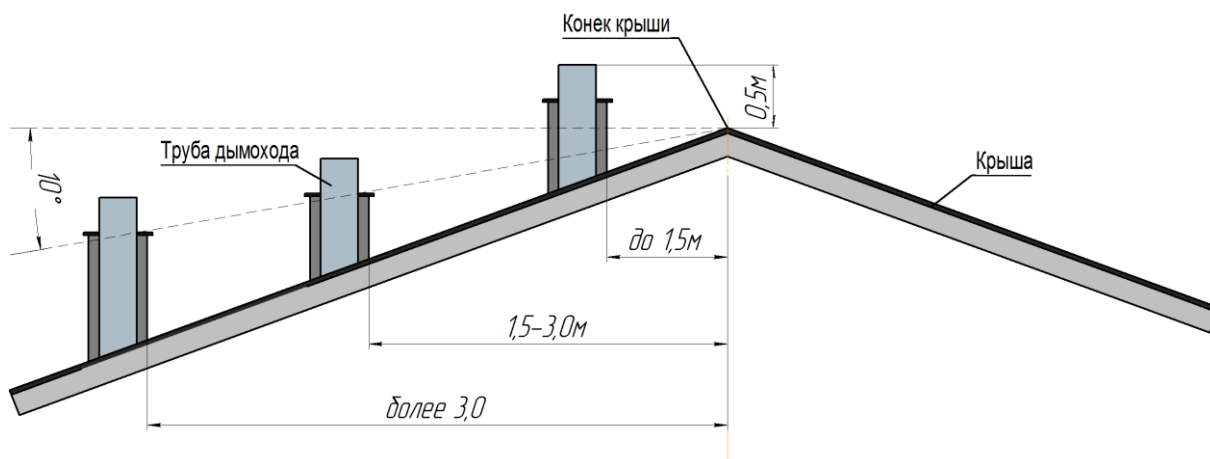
Рекомендованная схема размещения дымовой трубы над гребнем крыши.
